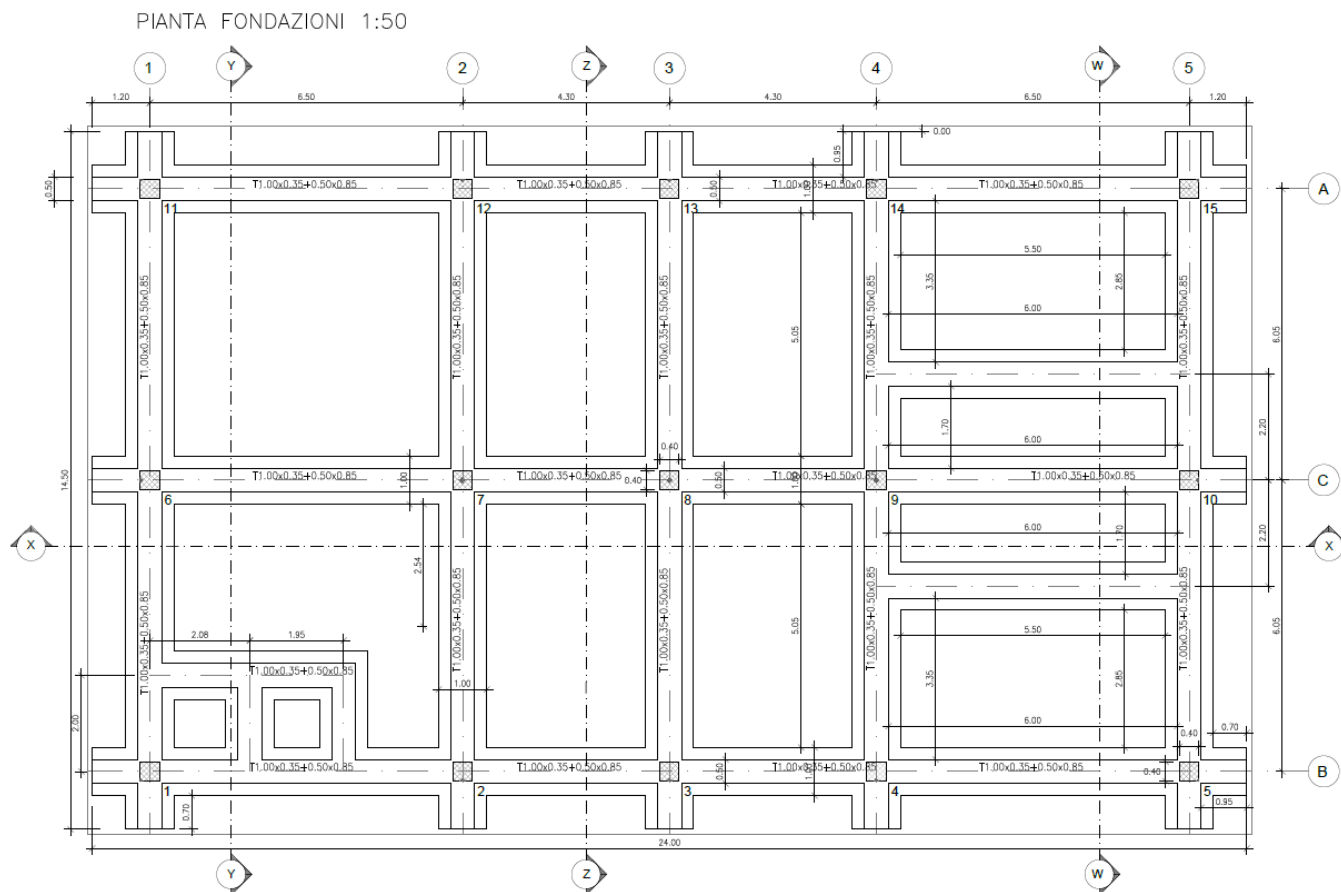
Esempio di pianta fondazioni per strutture come quella in progetto
